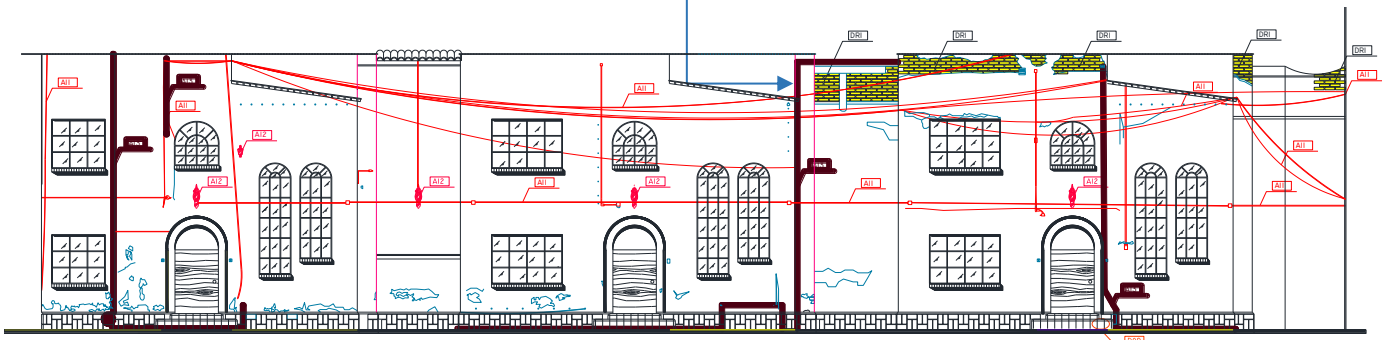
Estado actual de la fachada edificio siglo XIX y de las fachadas de las casas siglo XX.
